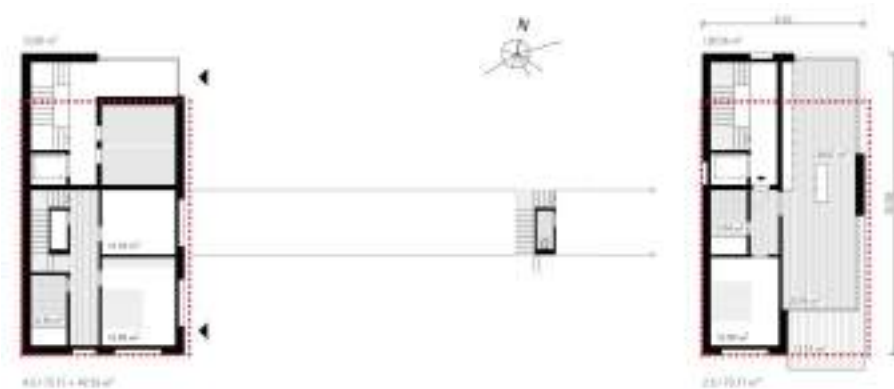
Einzelgebäude (1) und (3): Unter- oder Obergeschoss. Regelgeschoss (Stand: Richtprojekt)
